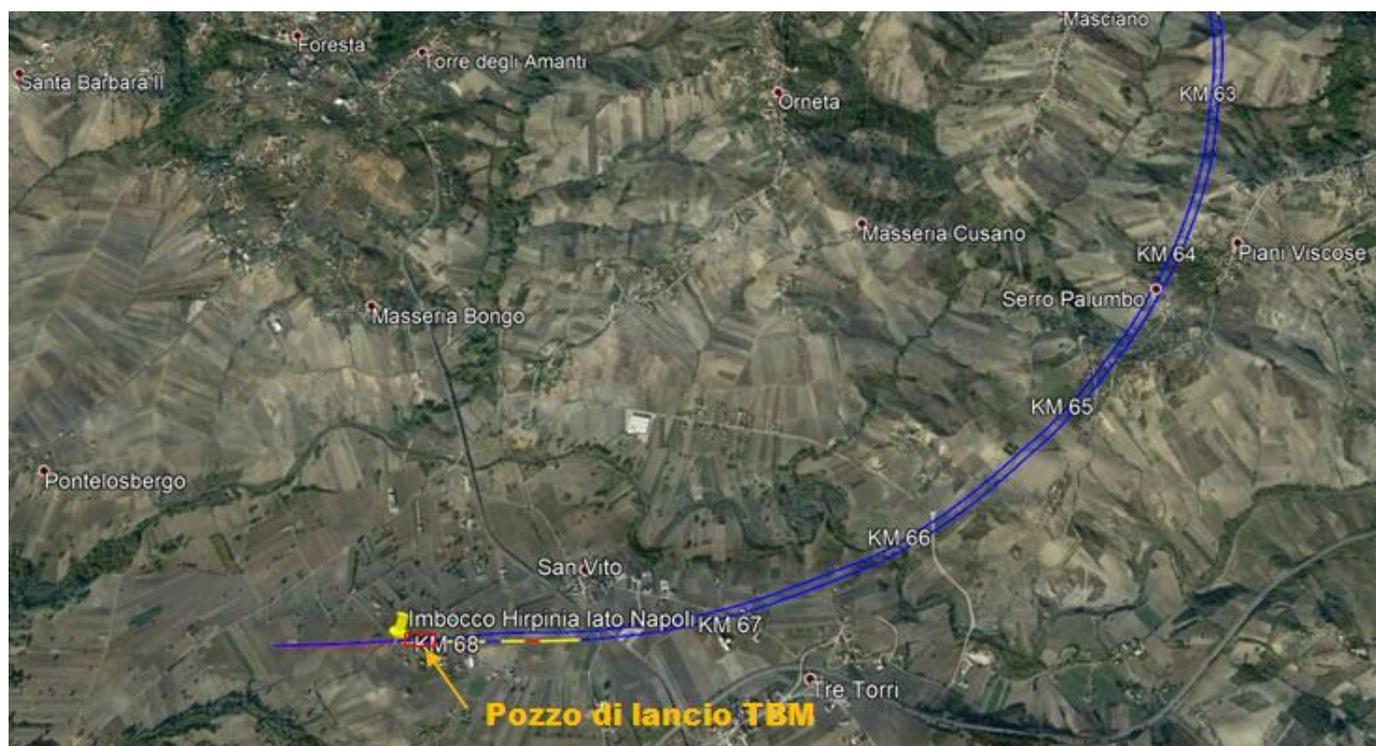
Stralcio planimetrico galleria Hirpinia lato Napoli con indicazione dell'ubicazione del pozzo di lancio TBM
